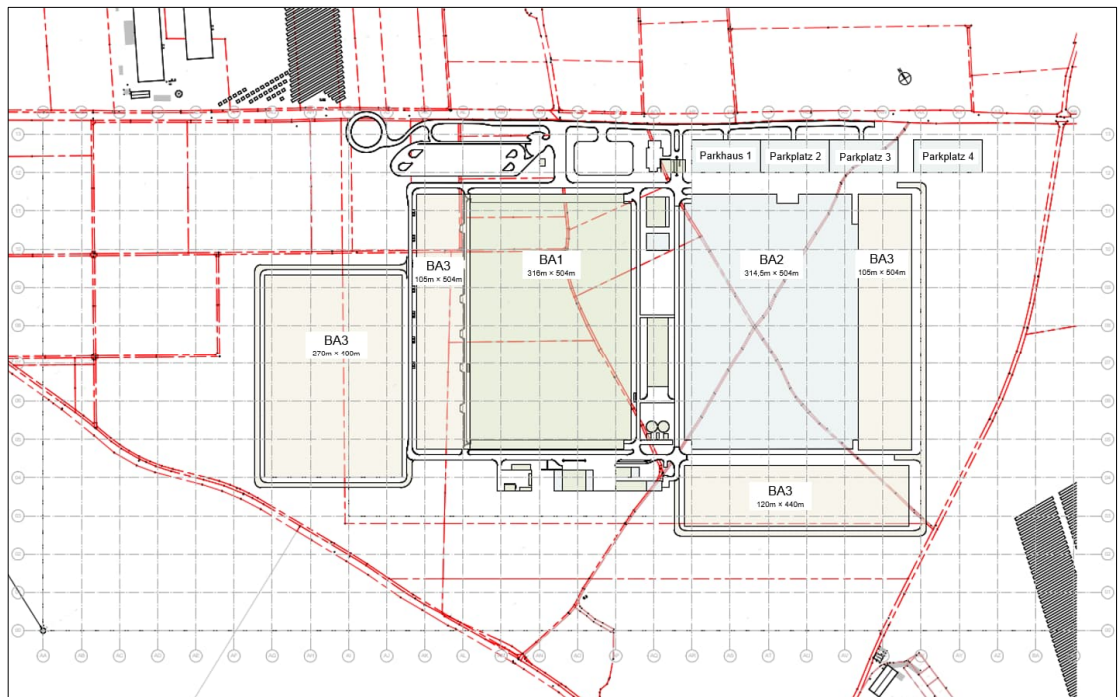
Planfall 2 mit Gebäuden (BA1 hellgrün, BA2 hellblau, BA3 gelb)
